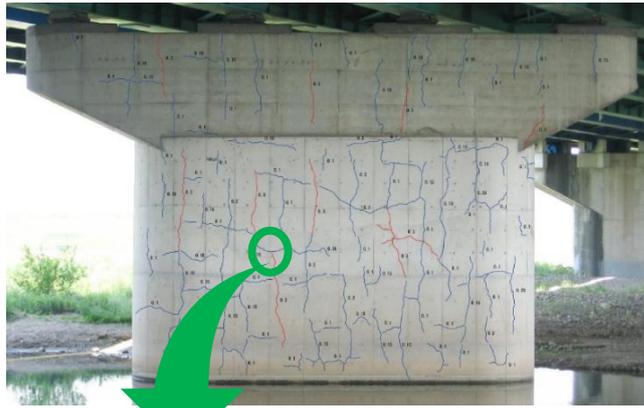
ひび割れのデジタル化と高精度な記録の例
